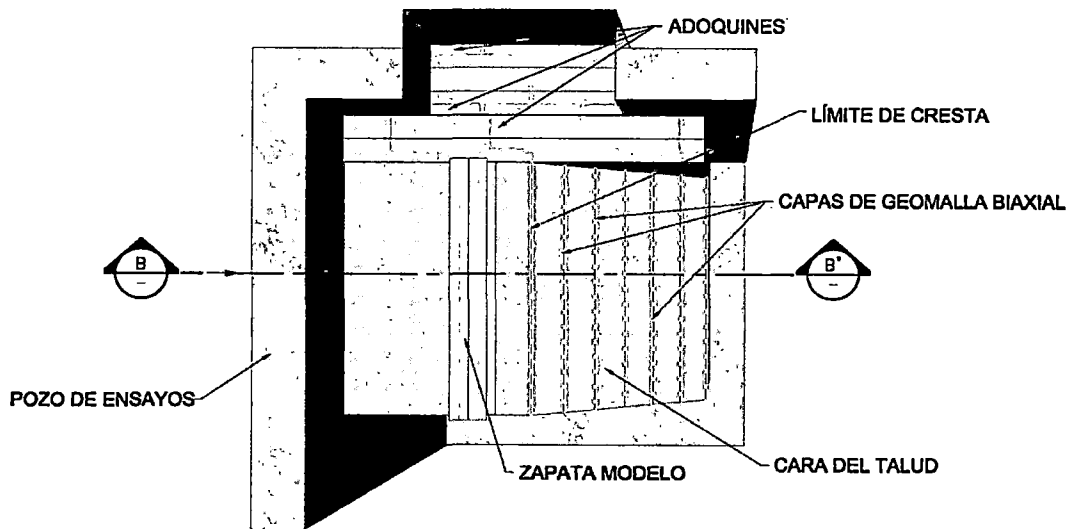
Vista en planta típica - Modelo TR en tres dimensiones
